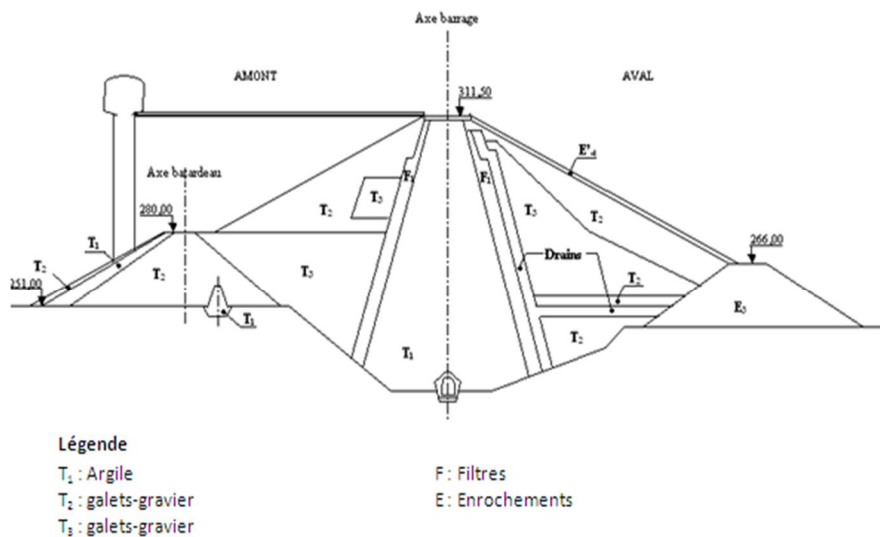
Profil en travers type du barrage (Tractebel, 2000b)
